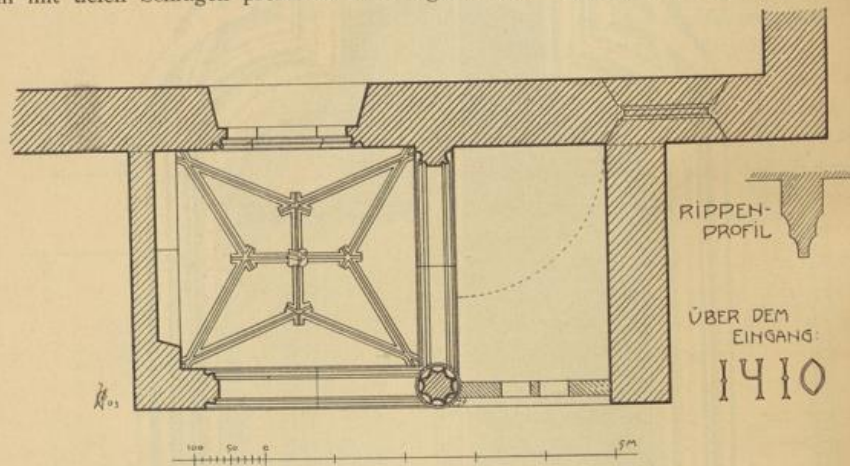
Kirchzarten. Kirche. Grundriss der Vorhalle.
